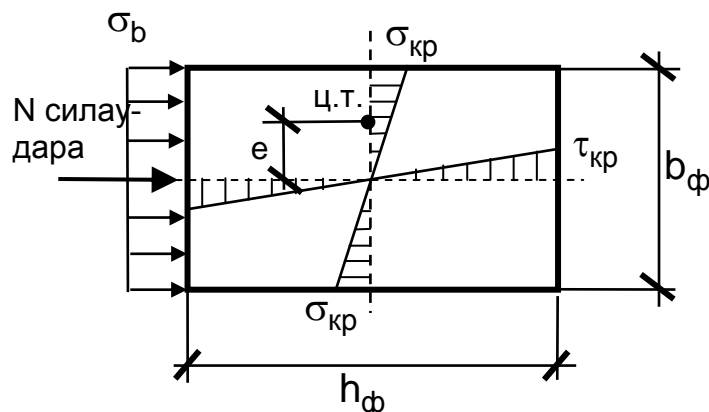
Схема поперечного сечения над фундаментной частью сооружения
